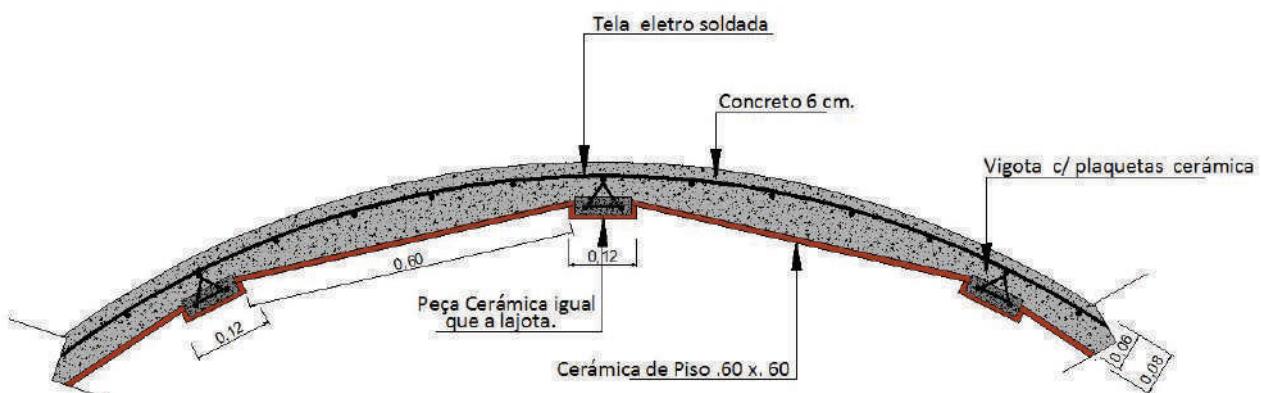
Abóboda com vigotas treliçadas de concreto e tavelas de cerâmica. (*)-5
